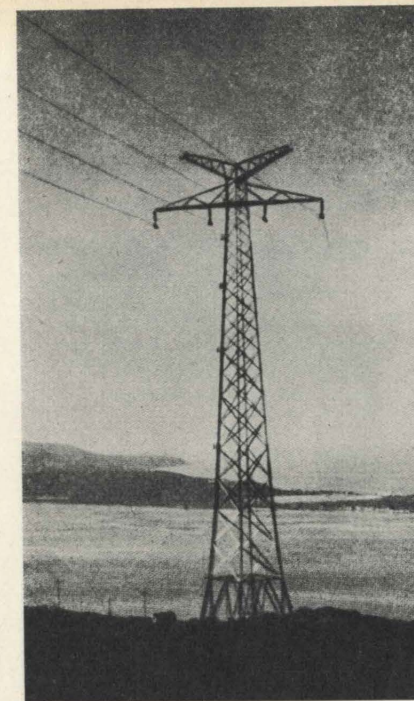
Attraversamento dello Stretto di Messina visto dalla costa calabra.
